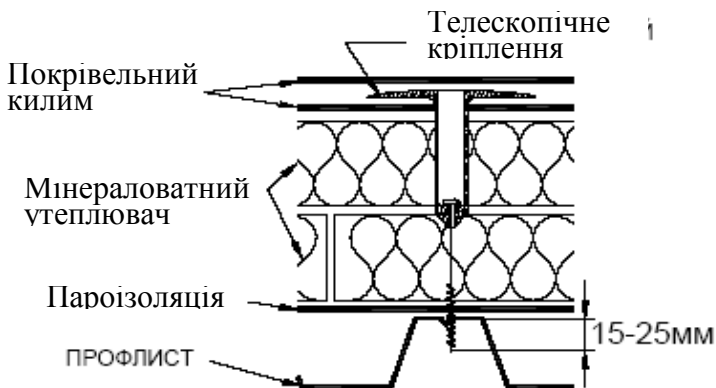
Установка "телескопічного" кріплення утеплювач
